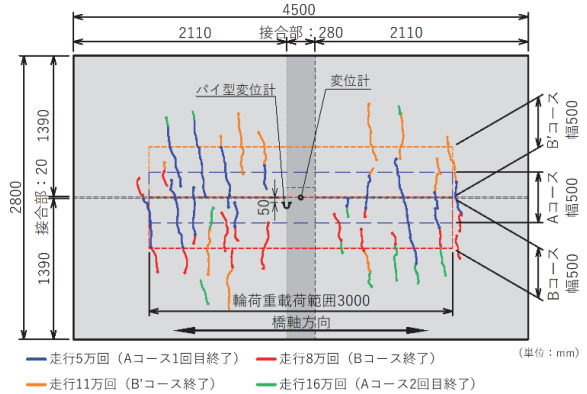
床版下面のひび割れ状況（縦横目地試験体）
